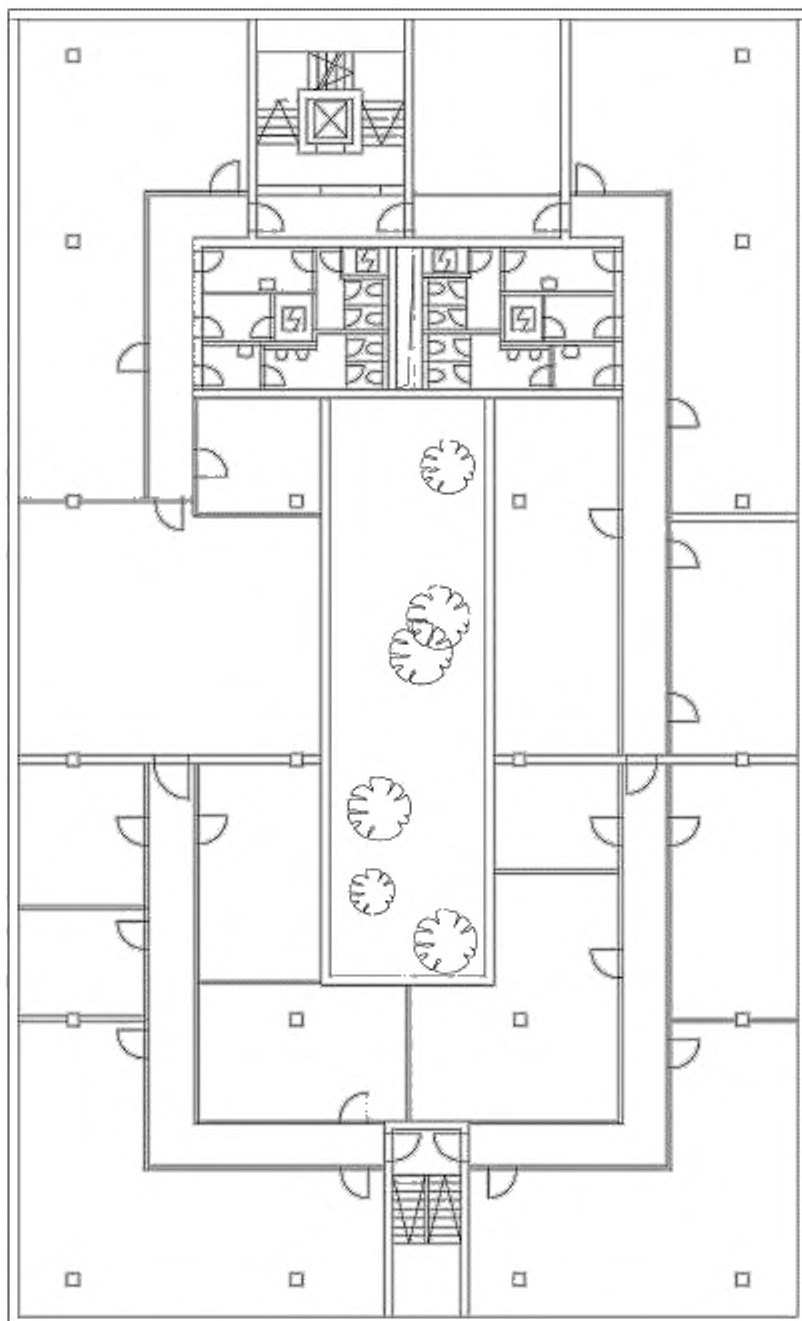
План этажа с указанием объектов, площадь которых входит во внутреннюю площадь этажа
